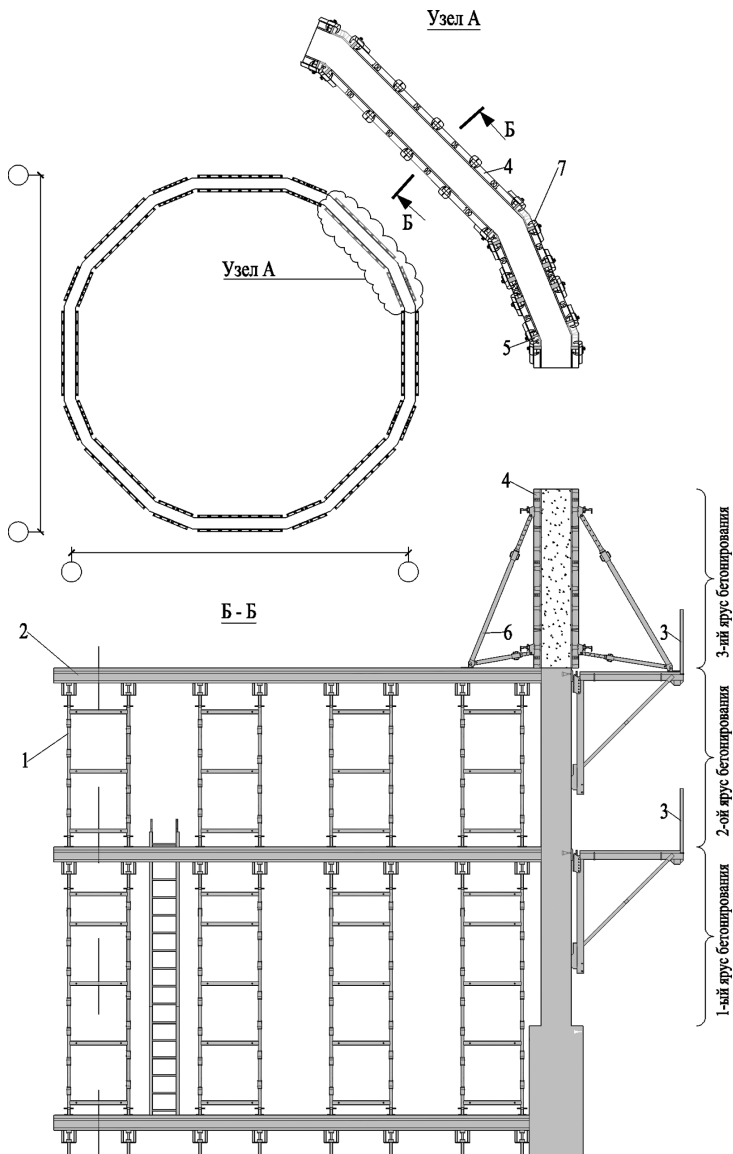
Схема опалубки наружных стен Храма в Честь Всех Святых:
